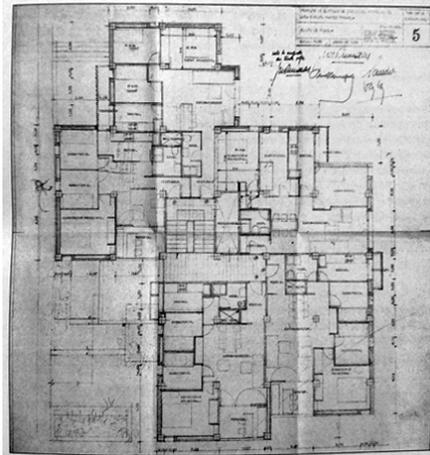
Poblado dirigido de Almendrales. Planta de bloque de vivienda.
